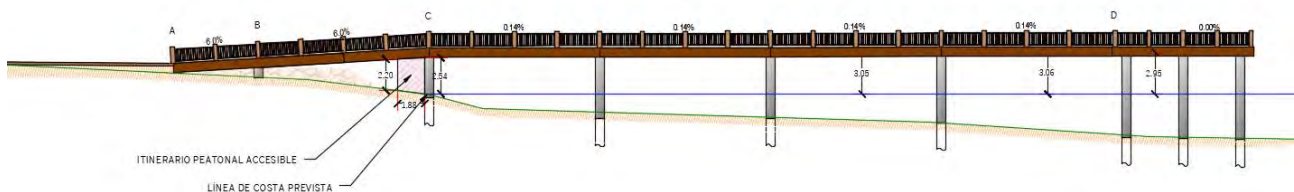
Captura del Plano 02. Perfil longitudinal Alternativa 1 (Anexo 1 Planos).
